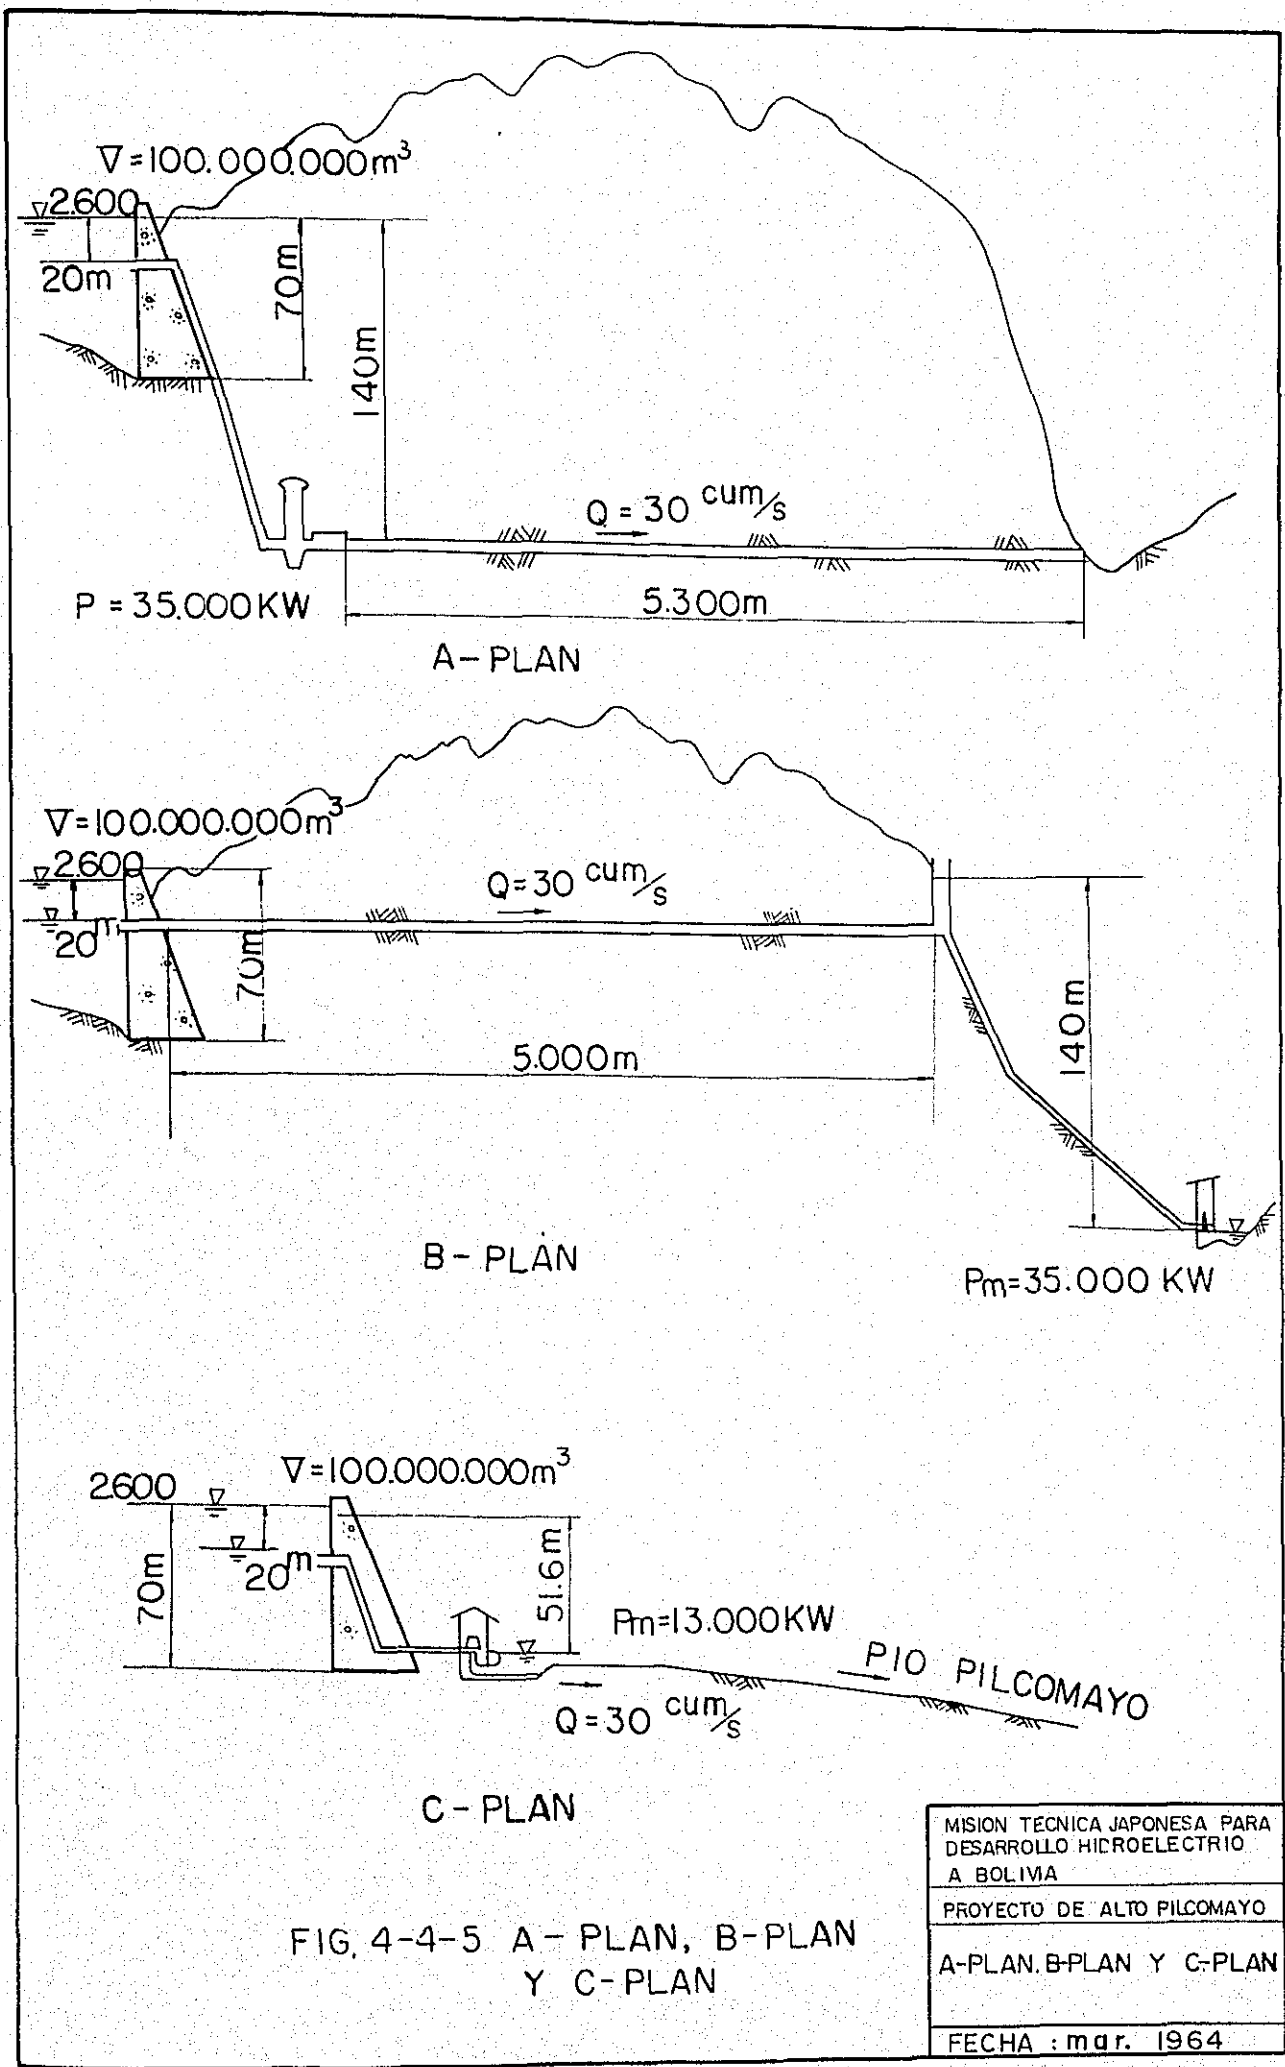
A-PLAN, B-PLAN Y C-PLAN
